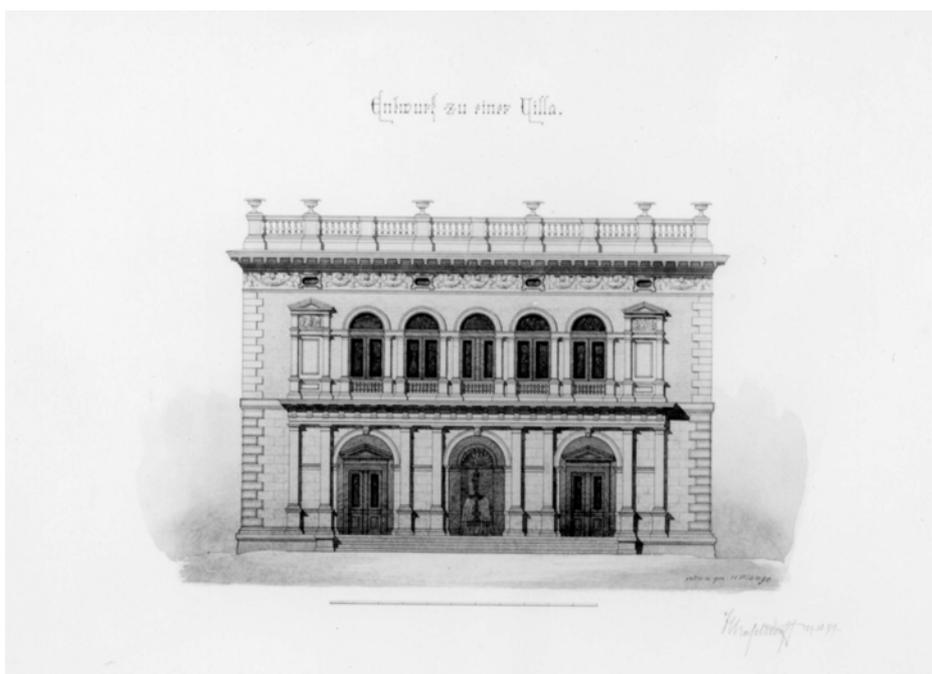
Heinrich Plange, Entwurf zu einer Villa, Fassade der Gartenseite, 1879
